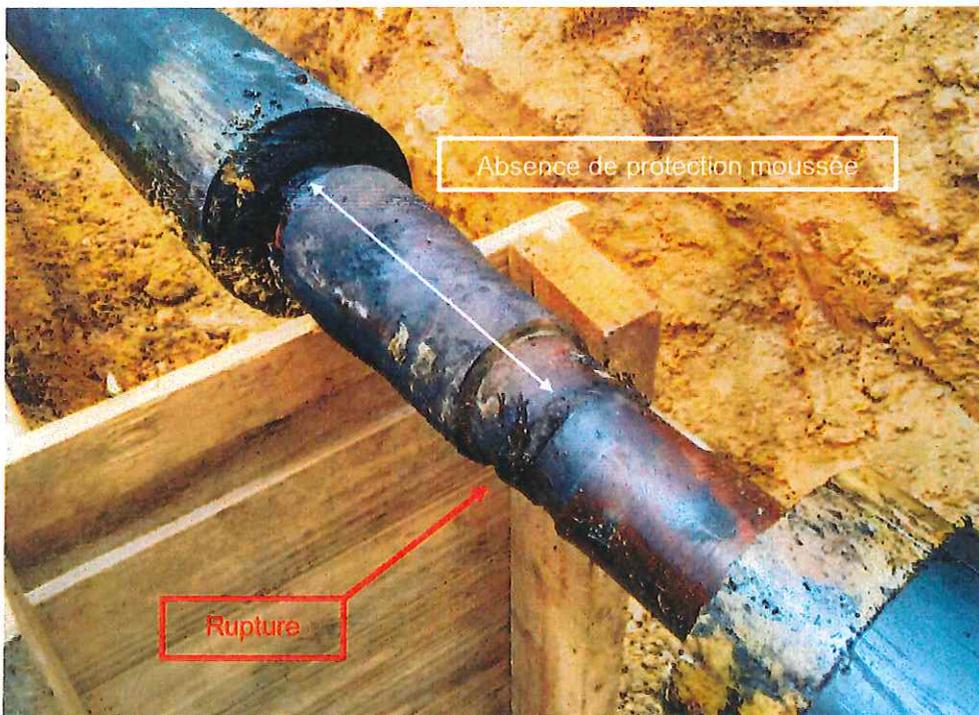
Rupture partielle de la conduite au niveau du joint de connexion.
